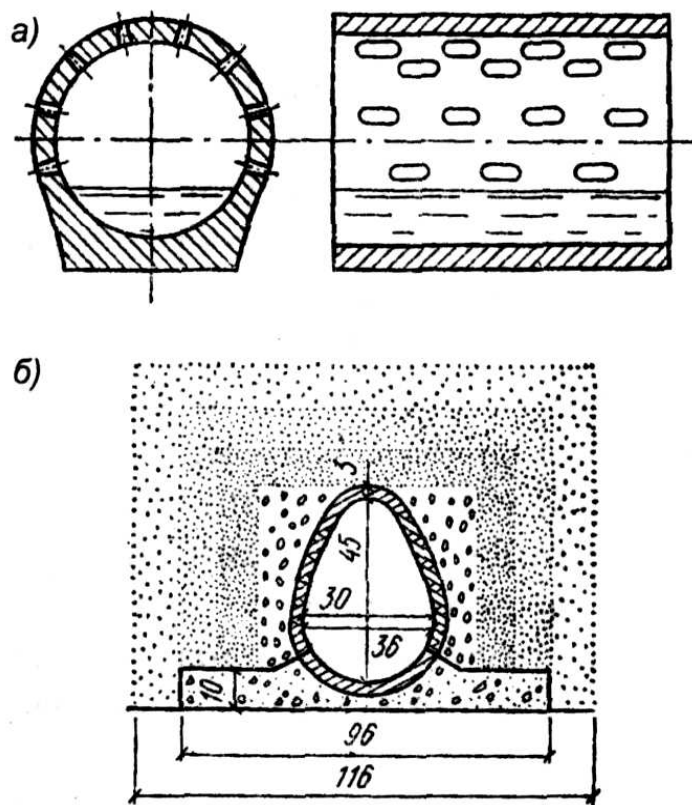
Перфорированные бетонные трубы круглого (а) и овоидального сечения (б)
